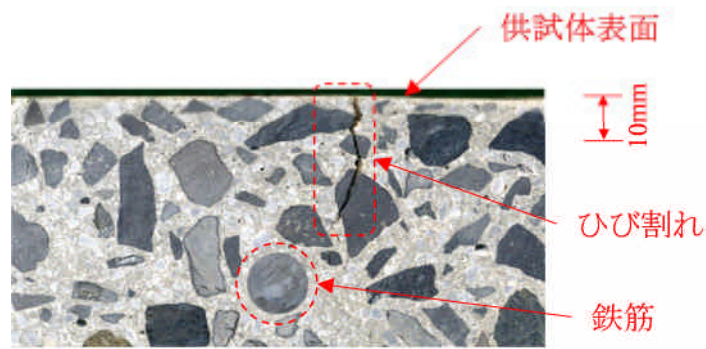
マップ状ひび割れが生じ、局所的に0.75mmと大きいひび割れ幅が認められた供試体の切断面
